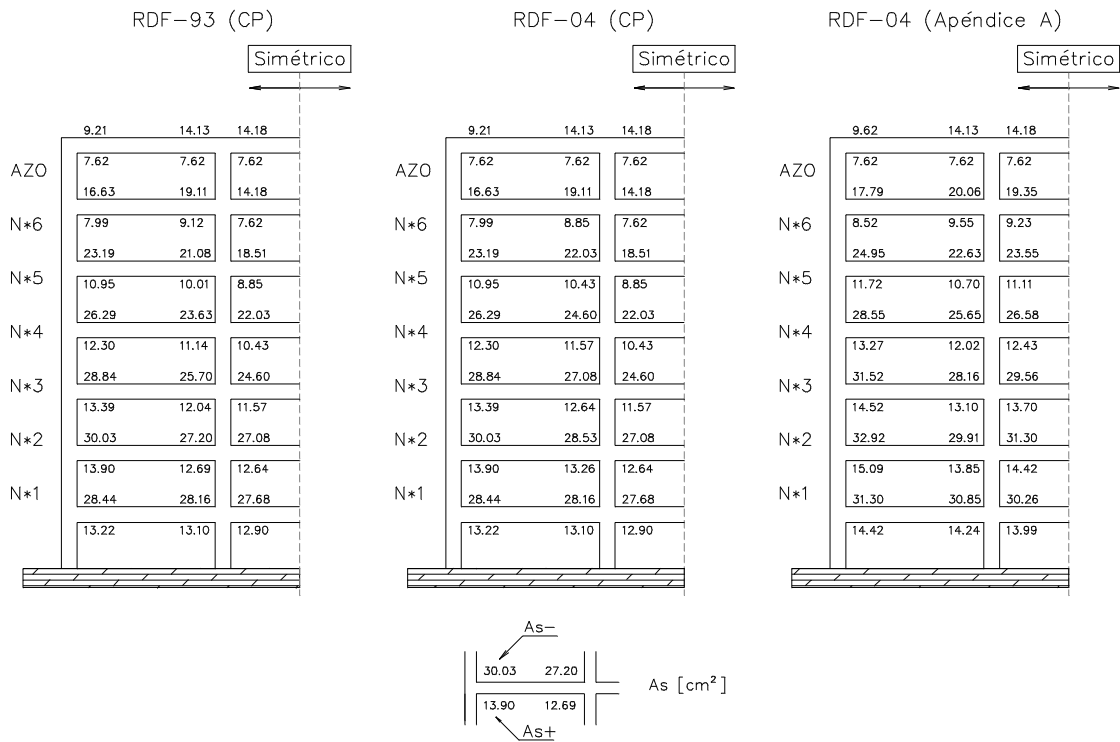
Comparación de áreas de acero de refuerzo longitudinal de las vigas del eje 2 de las estructuras diseñadas en zona II (RDF-93 y RDF-04)
